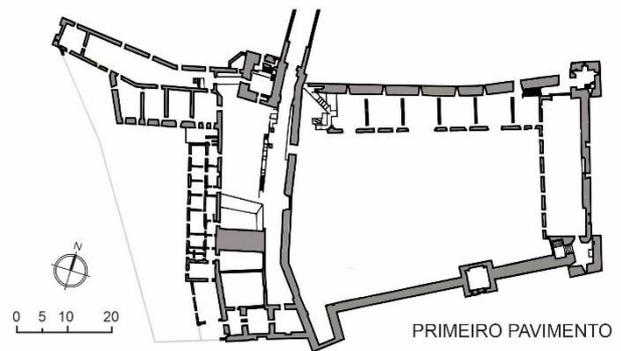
Planta baixa com a localização da intervenção e seus respectivos pavimentos em 1967
